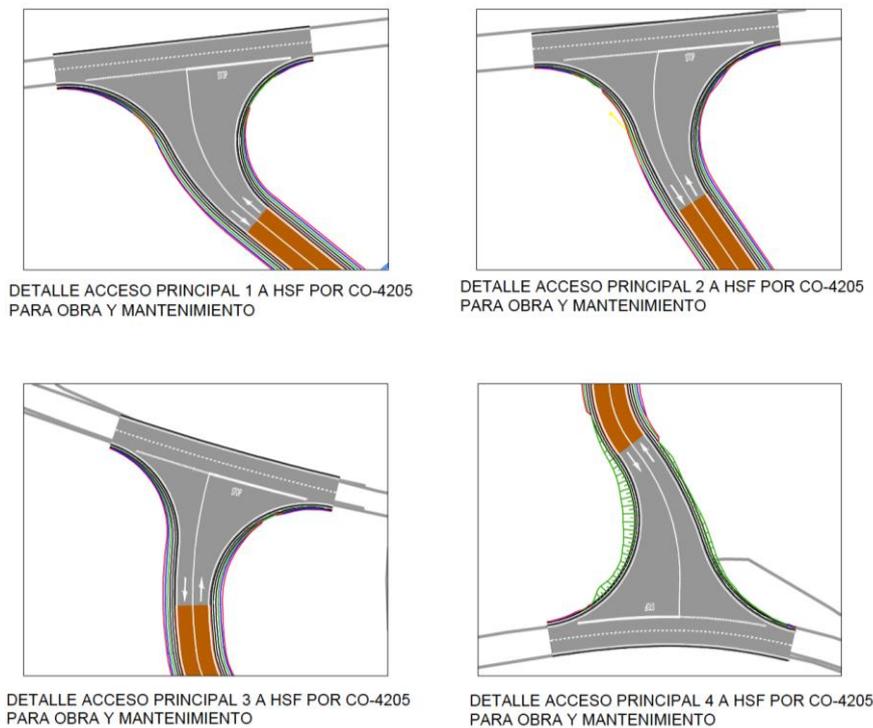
Accesos a la Planta Solar Fotovoltaica (Detalle).
